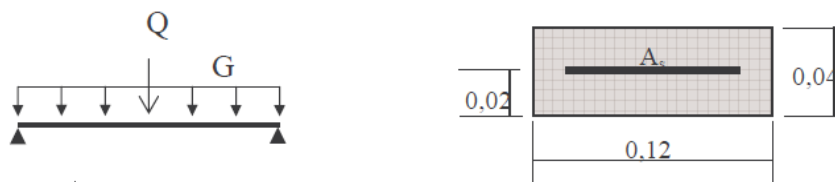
Modèle de calcul des poutrelles avant coulage
